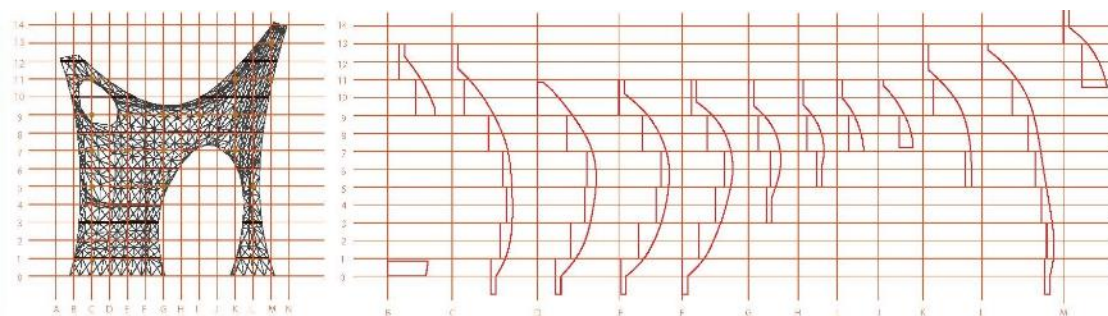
Secciones de la bóveda para el corte de las guías del falso cimbrado. Fuente: Planos realizados por los estudiantes y los autores
